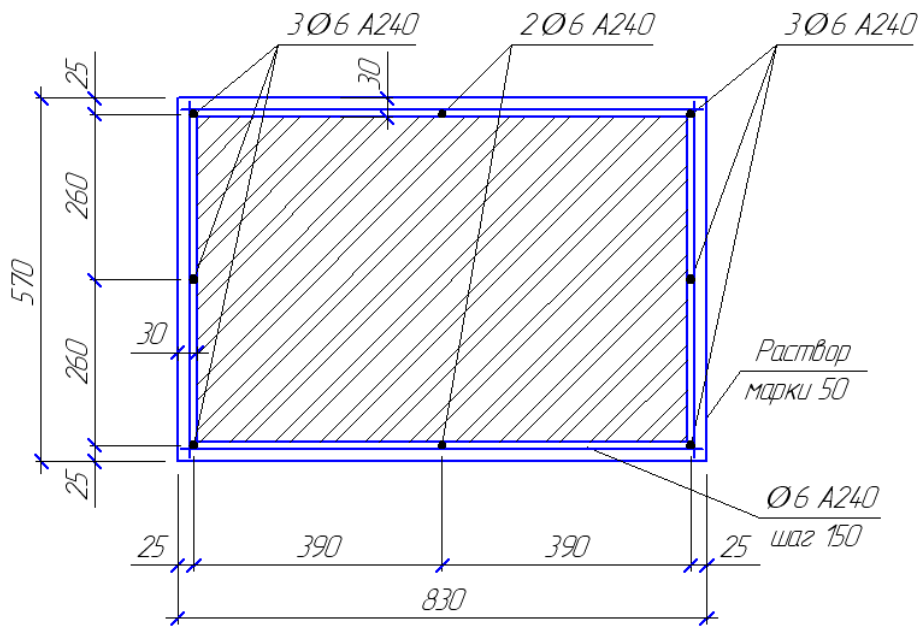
Схема усиление кирпичного столба армированной штукатуркой
